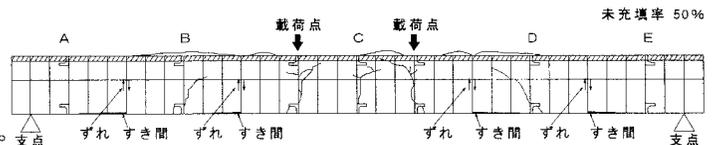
ひび割れ図(ダイヤフラムタイプ)
